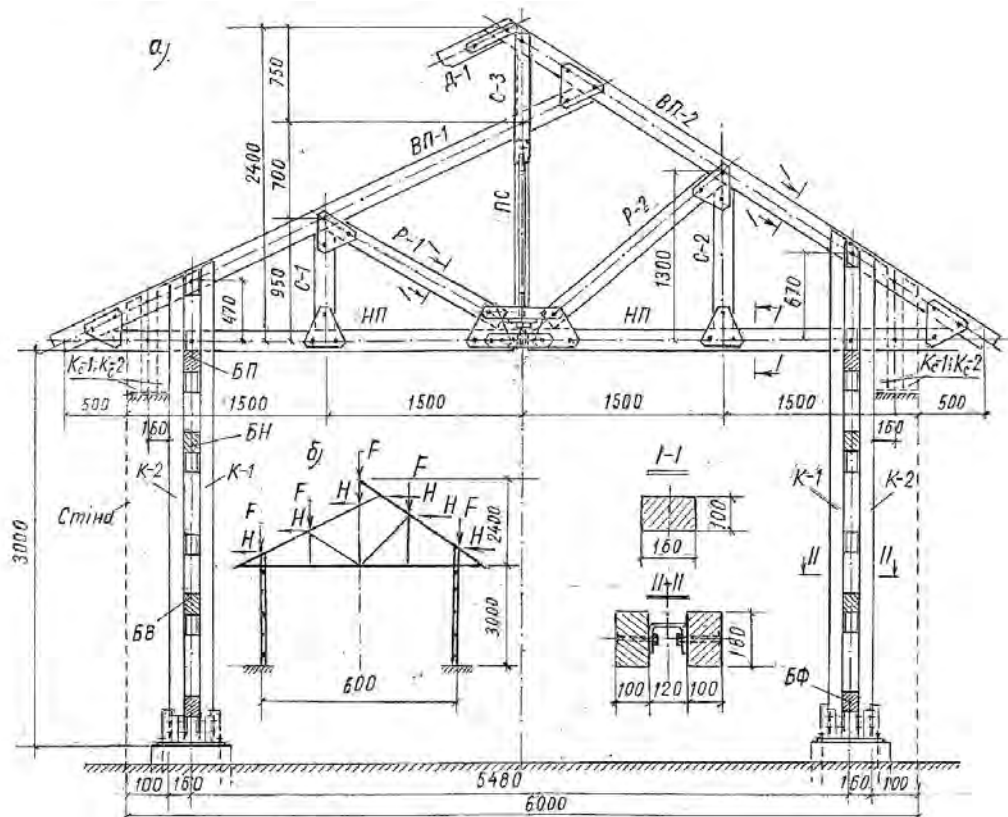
Дослідна конструкція рами каркаса одноповерхового будинку прольотом 6.0 м з одностінних збірних залізобетонних елементів перерізом 160 × 100 мм. К-1 і К-2 – збірні елементи двовіткових колон; БФ, БВ; БН і ПБ – фундаментні, віконні, надвіконні і підкроквяні балки стінових рам; НП; ВП-1; ВП-2; С-1; С-2; Р-1 і Р-2 – елементи ригеля рами у вигляді трикутних ферм; С-3 – стоек; РС – підвіска середня
